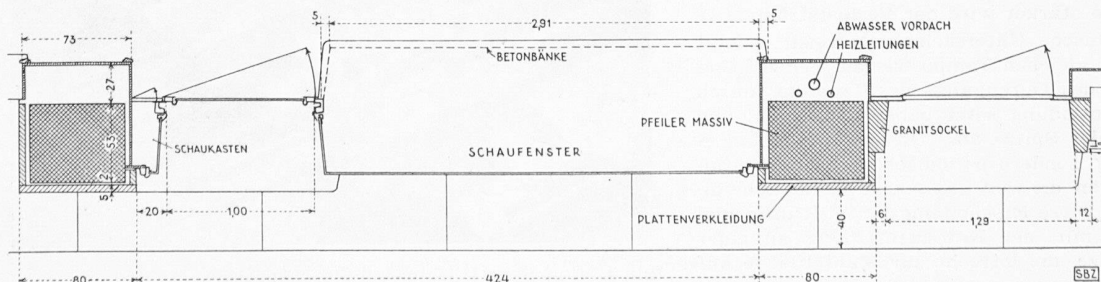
Grundriss der Schaufensterpartie 1 : 50
